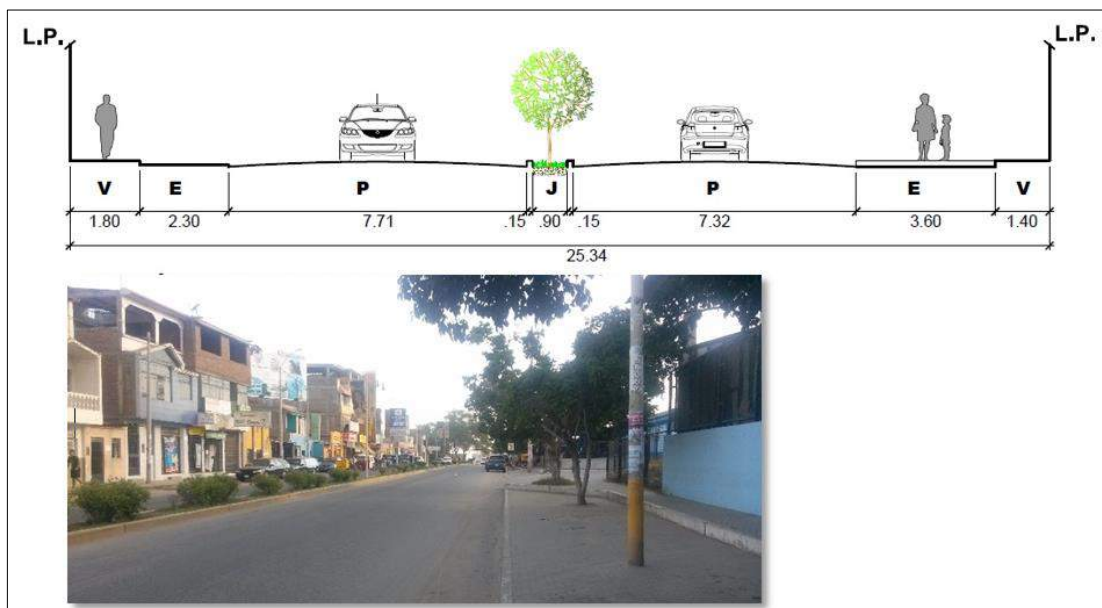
Sección Vial – Av. Santa Rosa (tramo 01)
